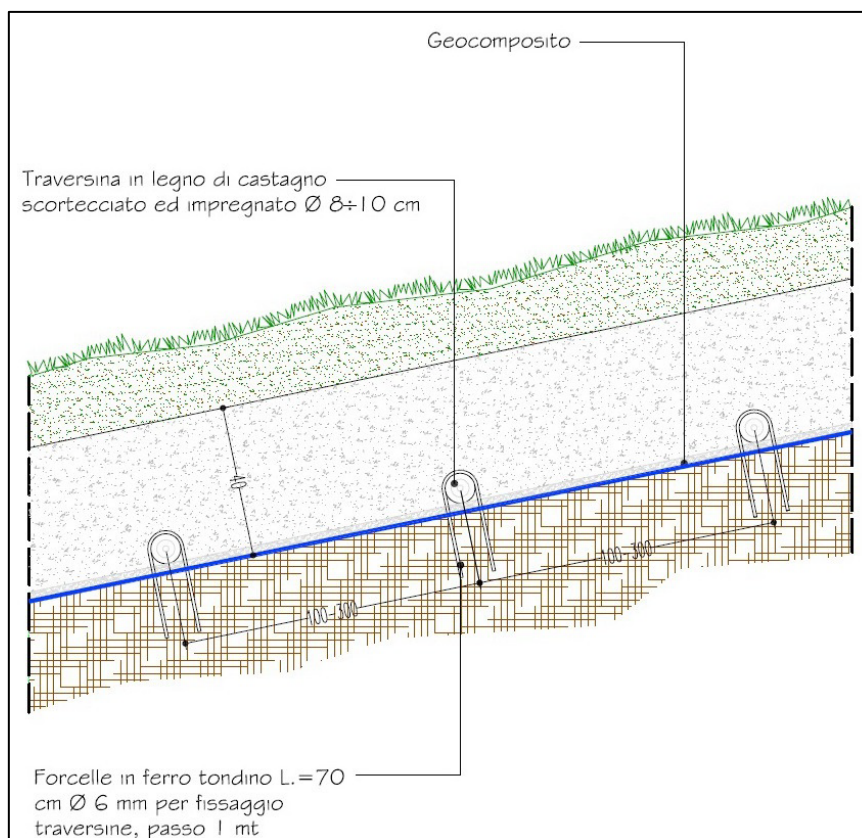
sezione longitudinale fosso impermeabilizzato con geocomposito tipo “Trenchmat
